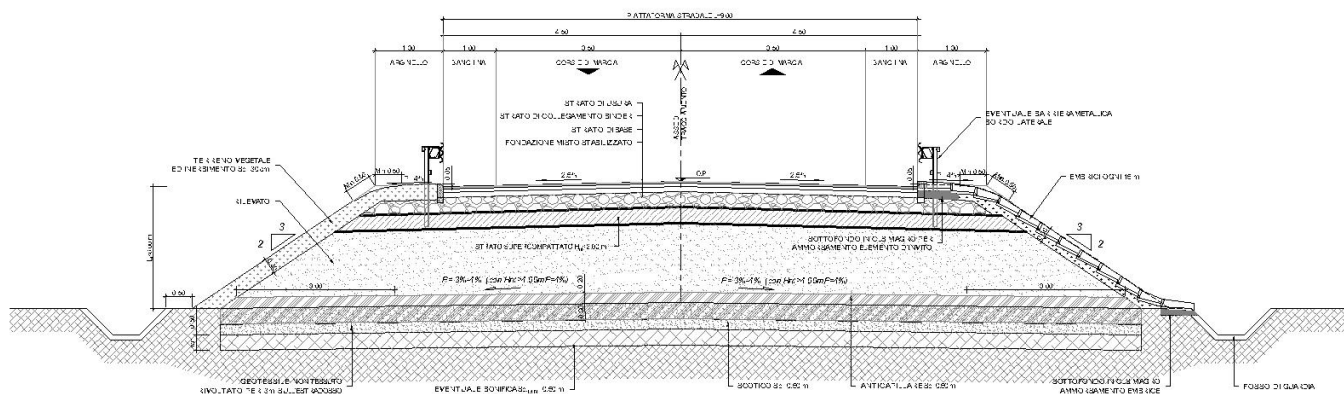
Cat. F1 sezione tipo in rilevato H_{ril} ≤ 6.00 m
